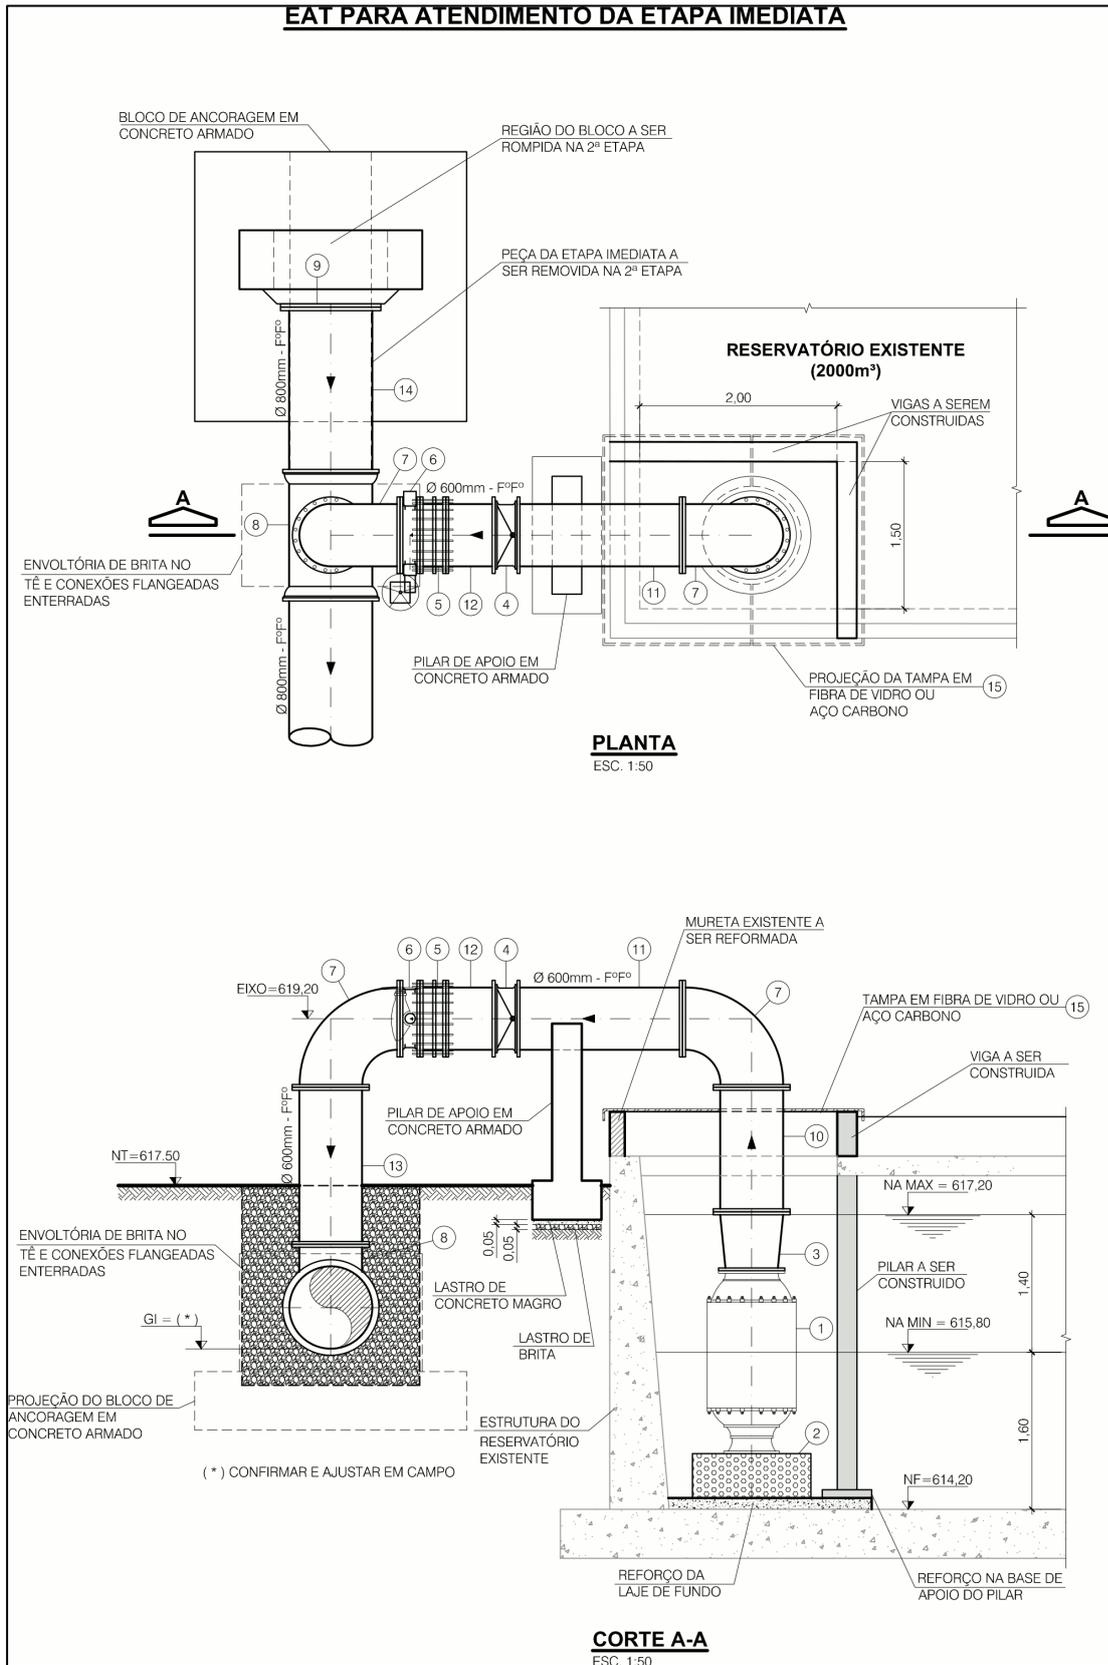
Planta e Corte da EAT 1ª Etapa.
